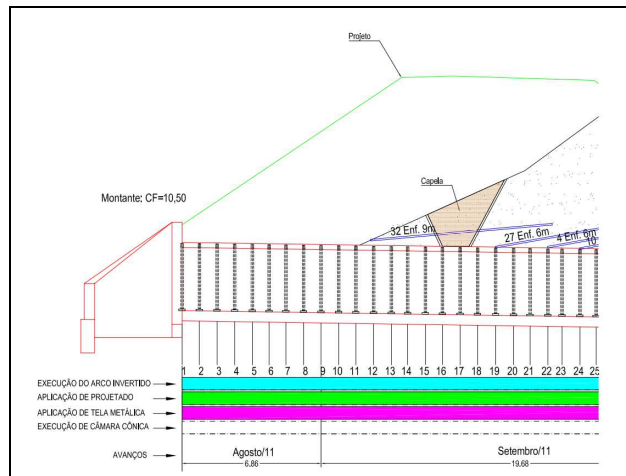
Perfil da capela formada a montante da escavação do túnel, “As Built” – Túnel Sob a BR-101 Parnamirim RN, 2011.
